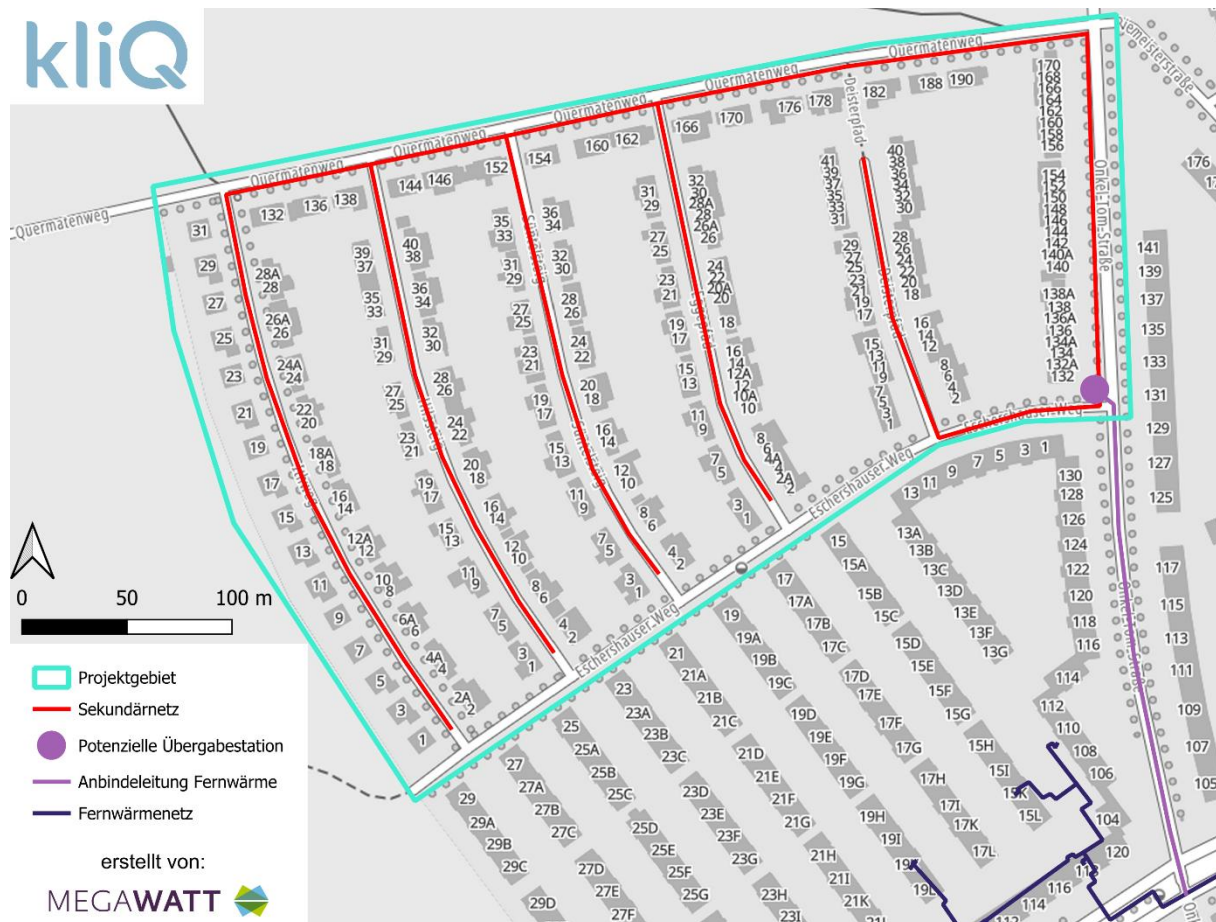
Lageplan des Sekundärnetzes der Fernwärme inkl. Übergabestation
